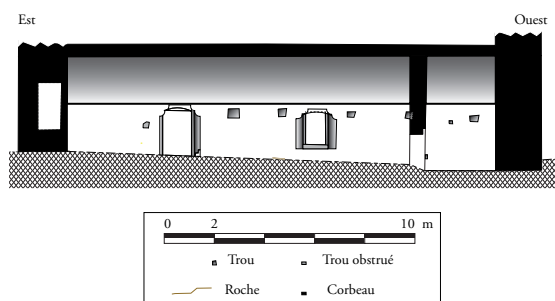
Coupe du mur sud (salle 2a et 2b)
